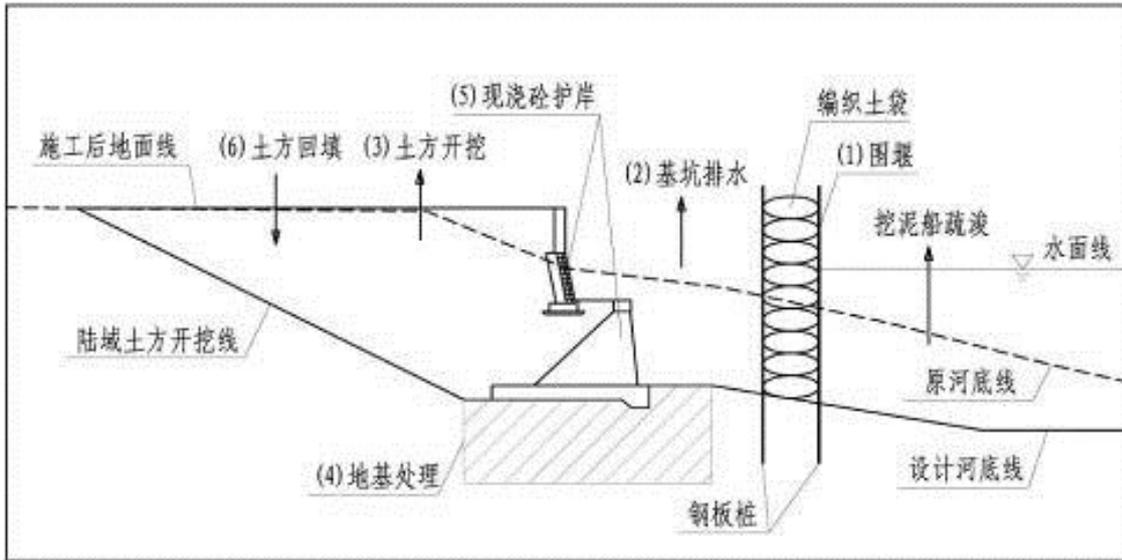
现状河岸相接处护岸施工示意图 (图中序号表示施工顺序)
